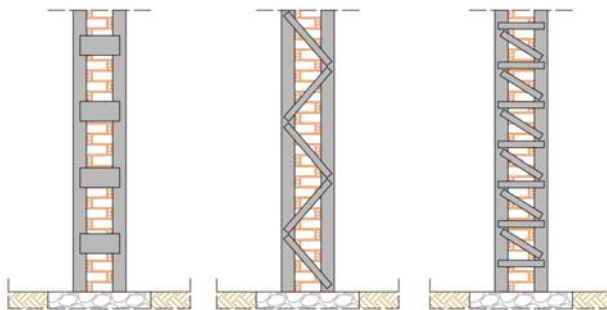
Refuerzo de pilar mediante encamisado con perfiles LPN. Fuente propia.
